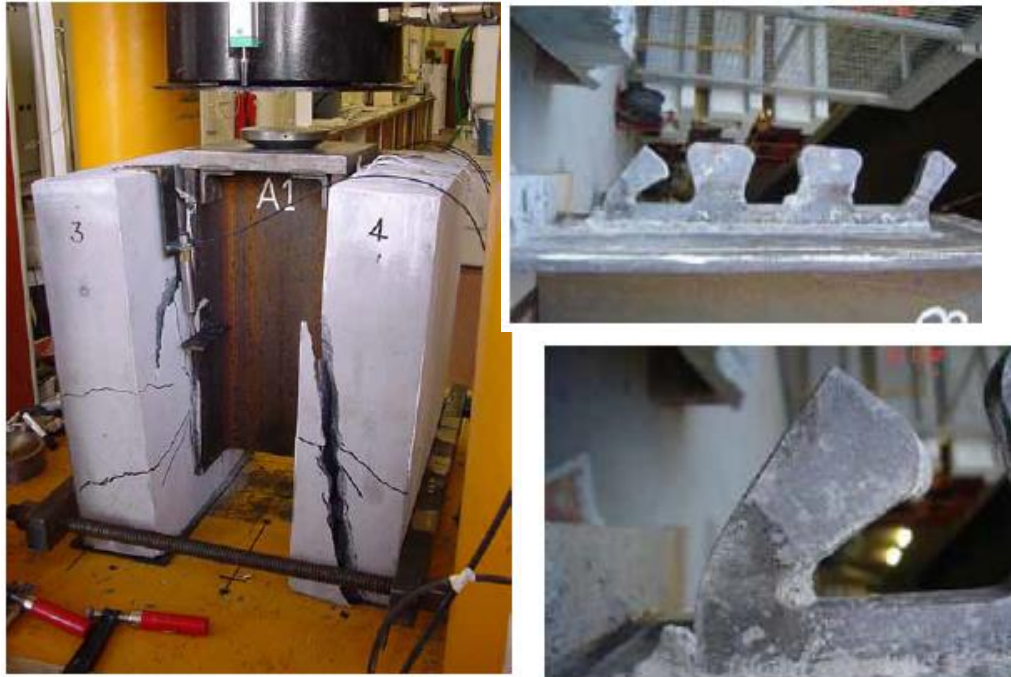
Conector Crestbond aplicado com pré-laje de concreto.
